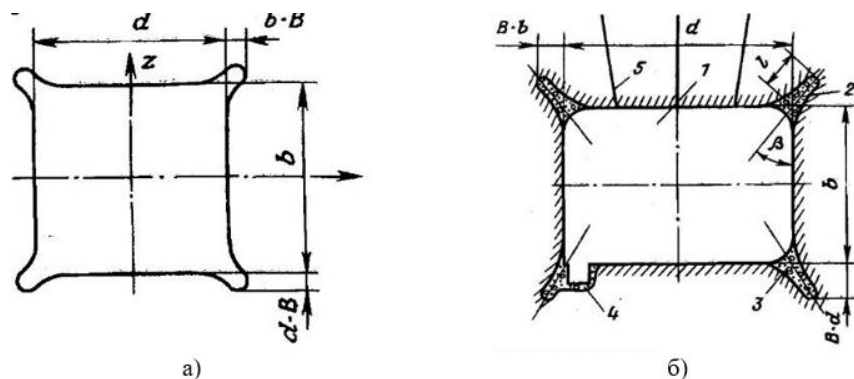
Четырехугольная выработка со щелями в углах: а) схема моделирования; б) сечение выработок в натуре; 1 – прямоугольная выработка; 2 – разгрузочная щель; 3 – бетонный наполнитель; 4 – водоотливная канавка, частично совмещенная с щелью; 5 – штанговая крепь [37]
